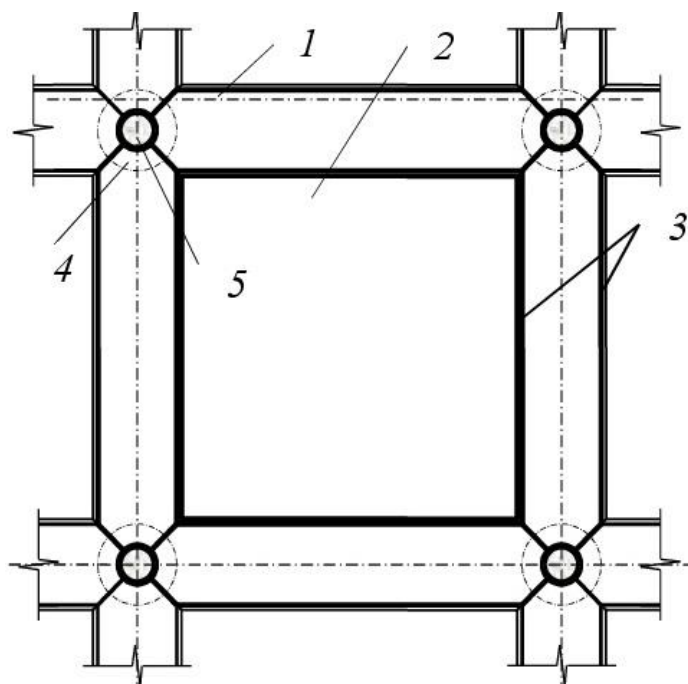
Фрагмент збірного сталезалізобетонного безбалкового перекриття з плитою:
